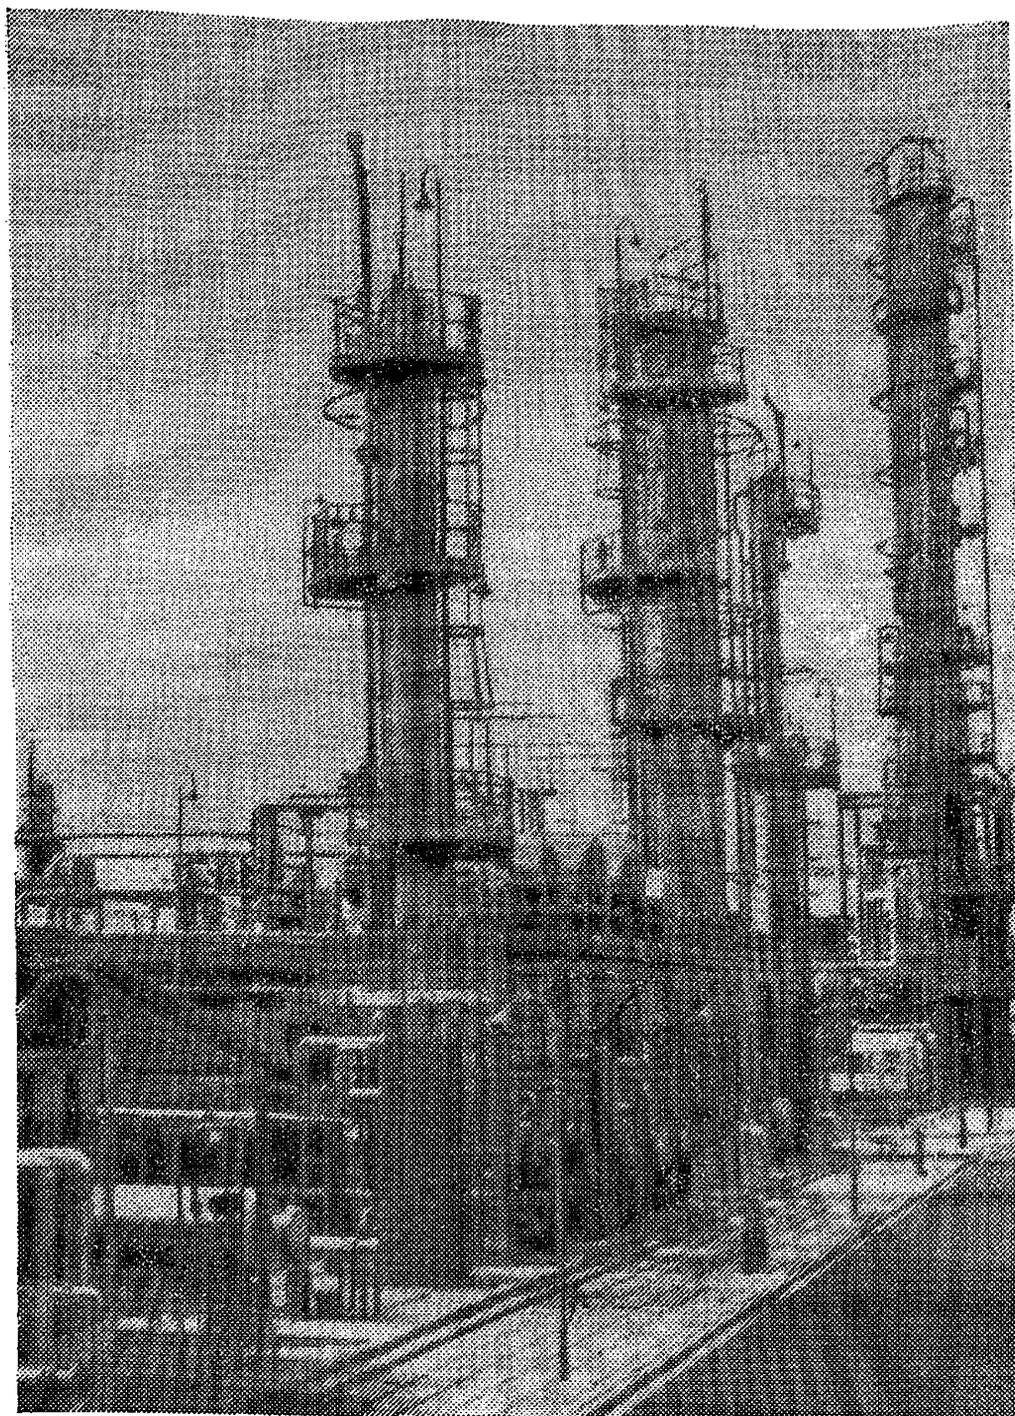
Площадки, опирающиеся на оборудование и имеющие собственные опоры, в застройке нефтеперерабатывающего завода
